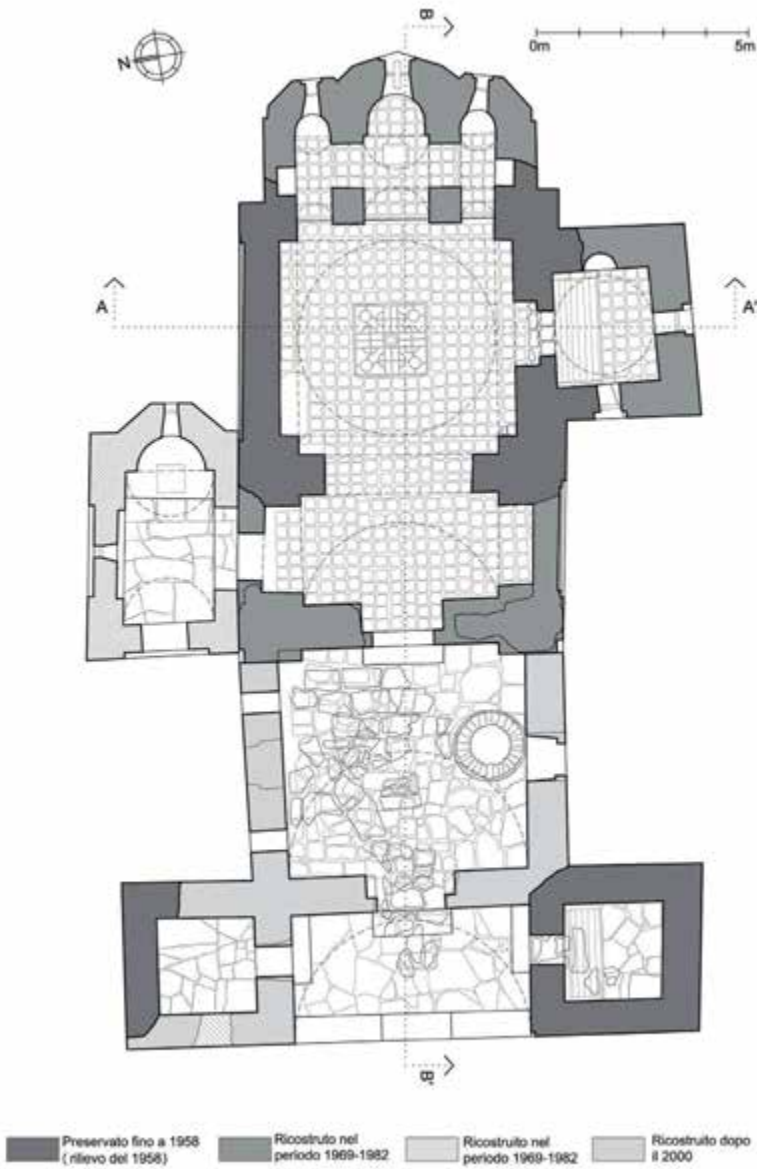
San Nicola dopo il restauro, pianta con le fasi di costruzione
